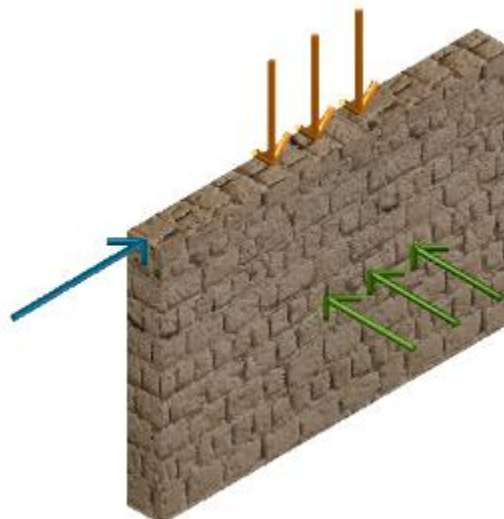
Trabajo de un muro de mampostería (Corzo, 2020)
